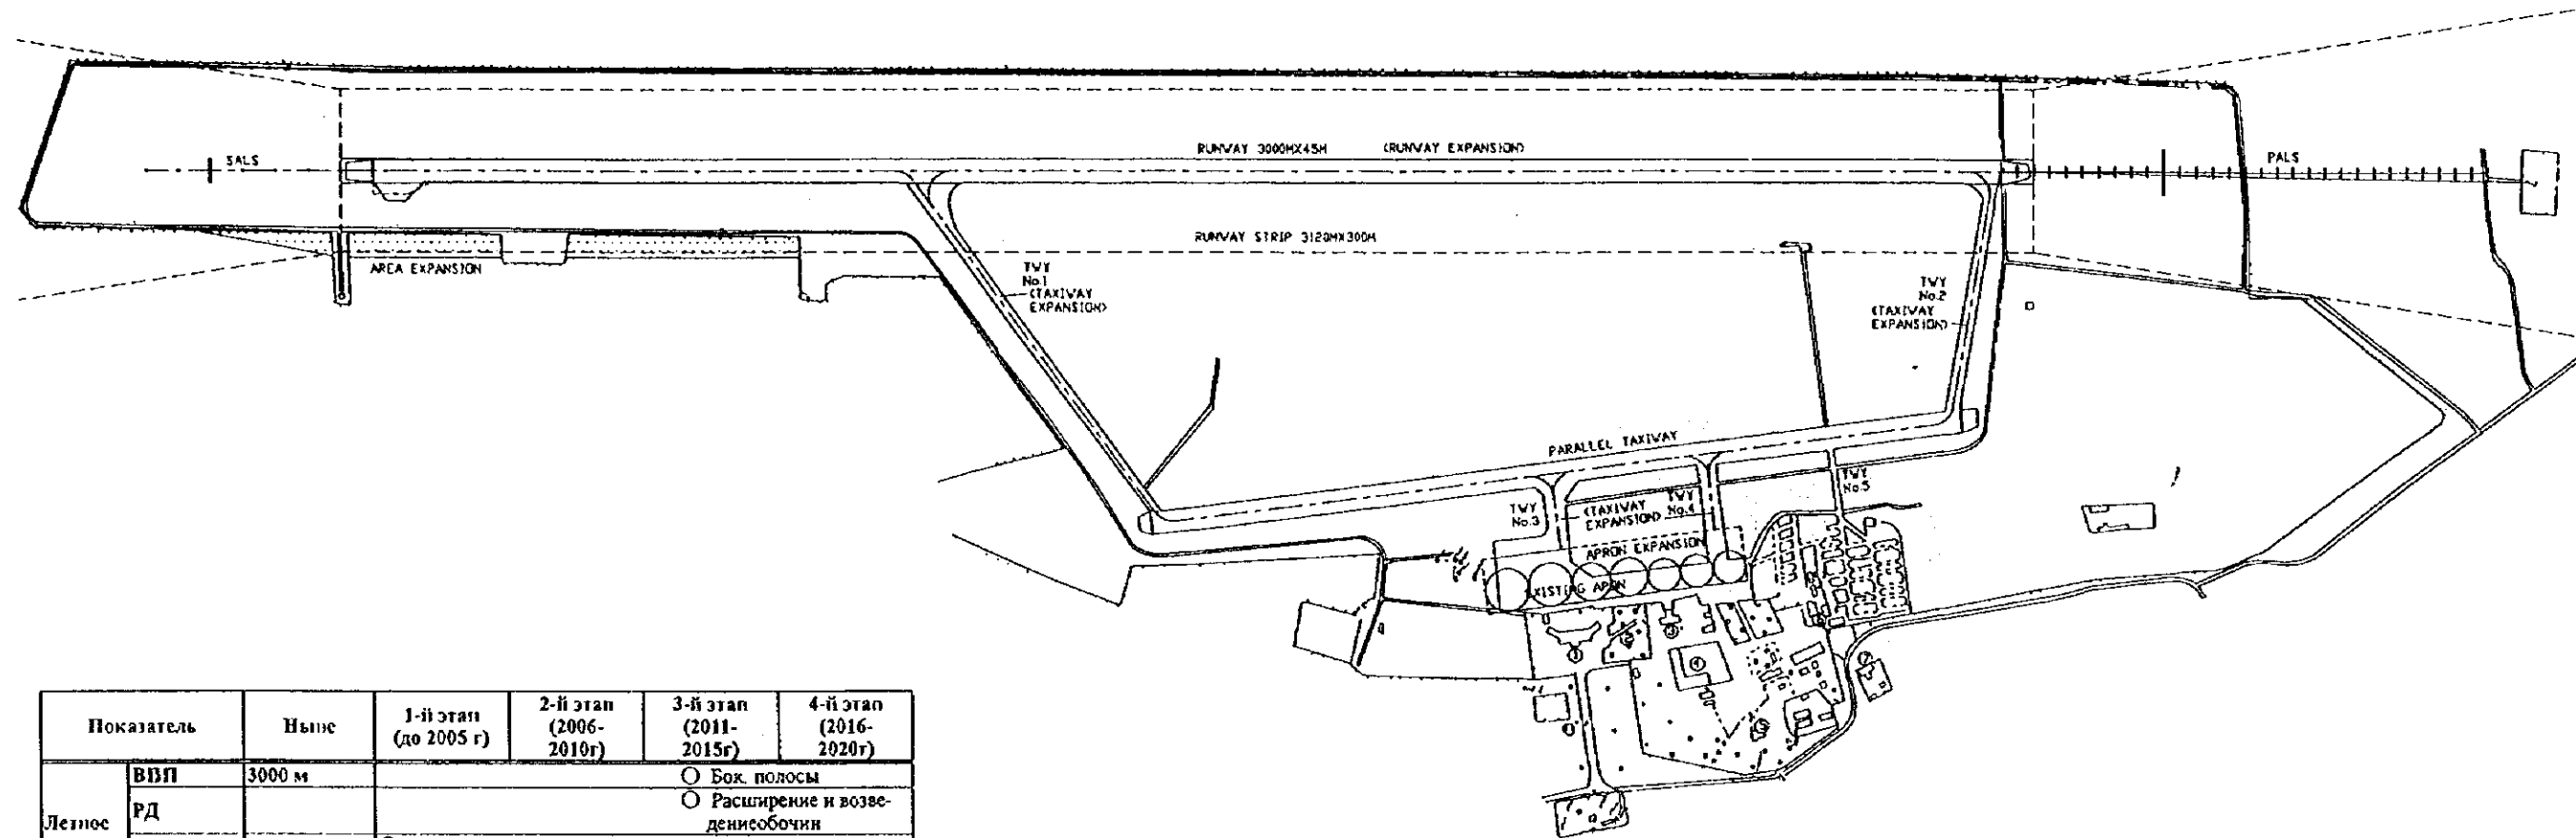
(1) План размещения аэровокзального комплекса аэропорта Термез (масштаб: 1/5000)
